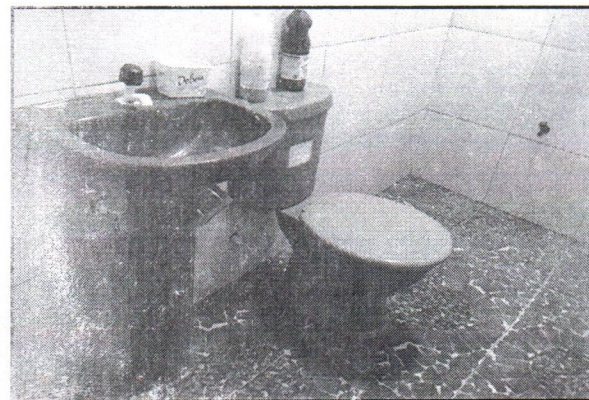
Imagem de Banheiro com piso e paredes de revestimento cerâmico
